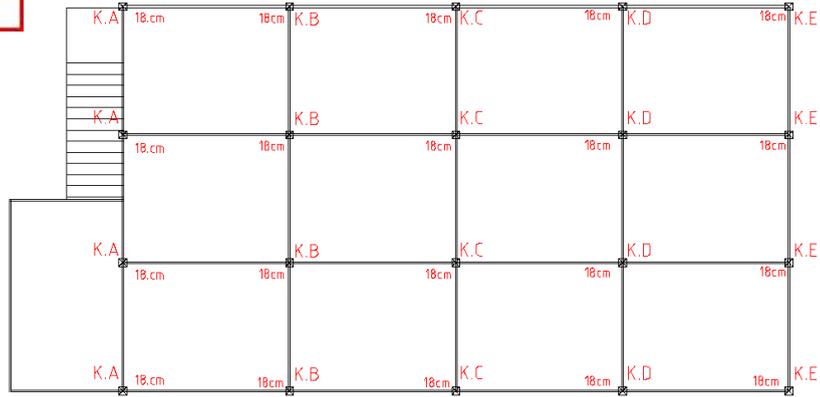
Struktur Konstruksi Balok Tanpa Pasak
